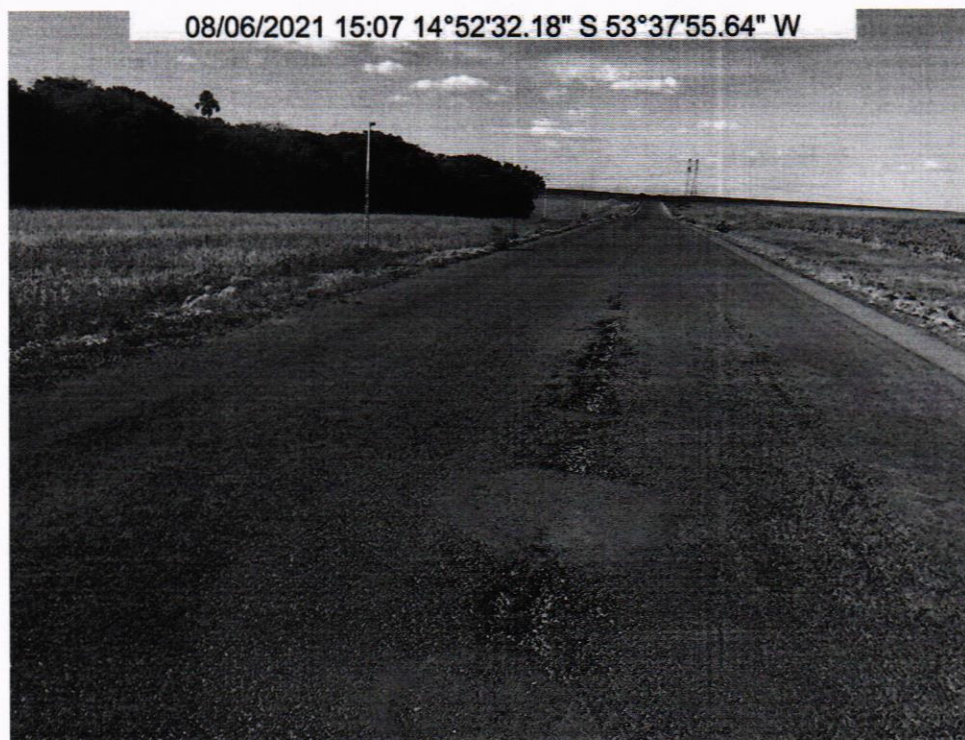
VISTA GERAL DO TRECHO - km 7,9
